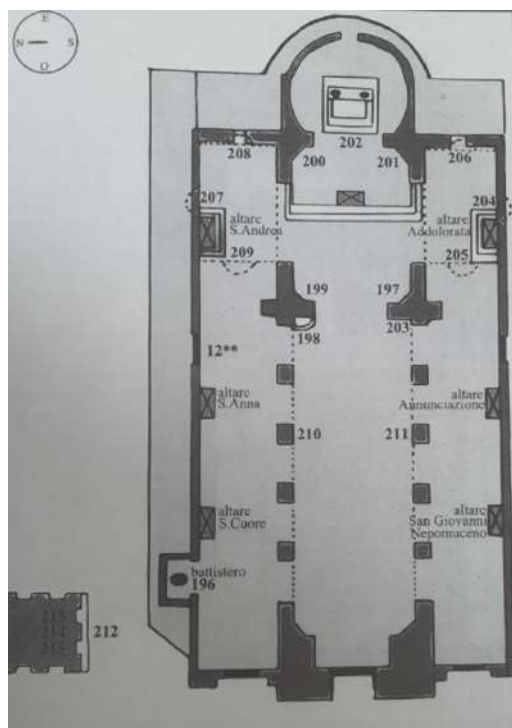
Pianta della nuova chiesa di Sant'Andrea.
